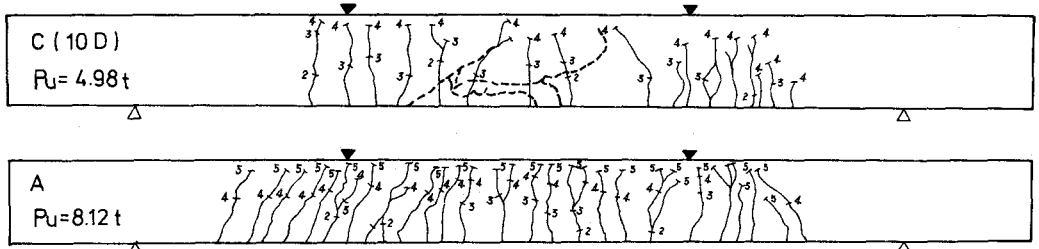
現場打コンクリート表面に発生したひびわれの一例
